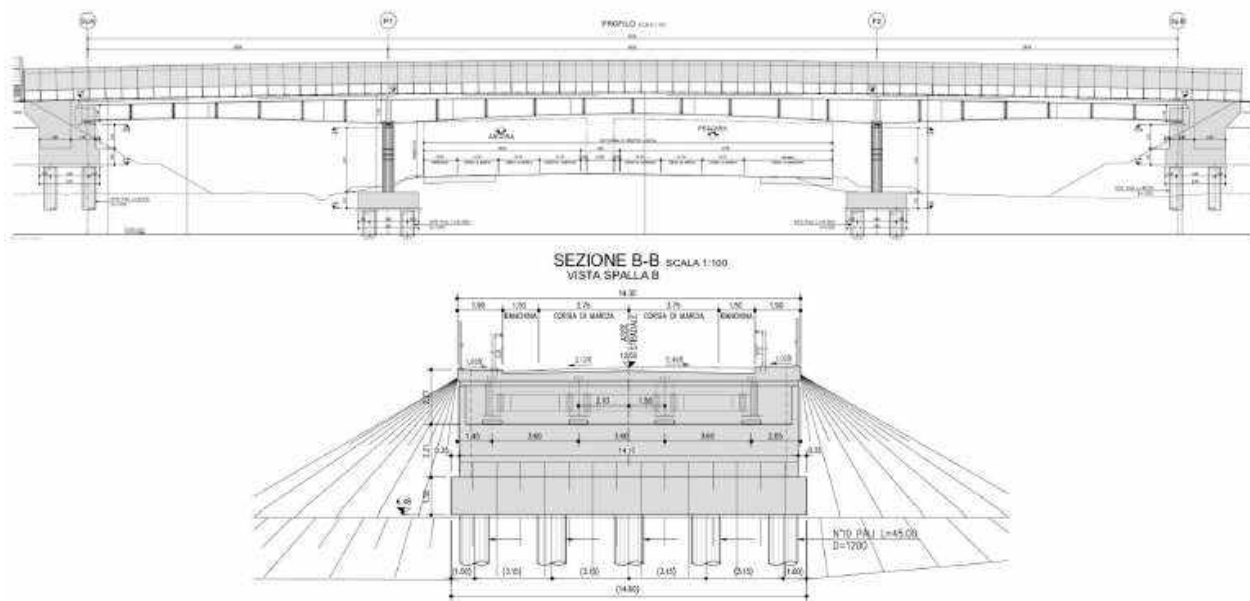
Prospetto e sezione del cavalcavia di svincolo
